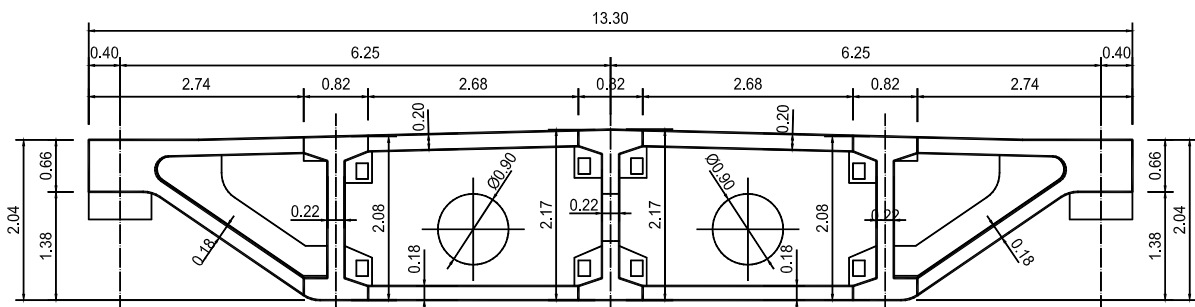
Section transversale du tablier du pont à haubans sur l'Oued Dib à Mila
